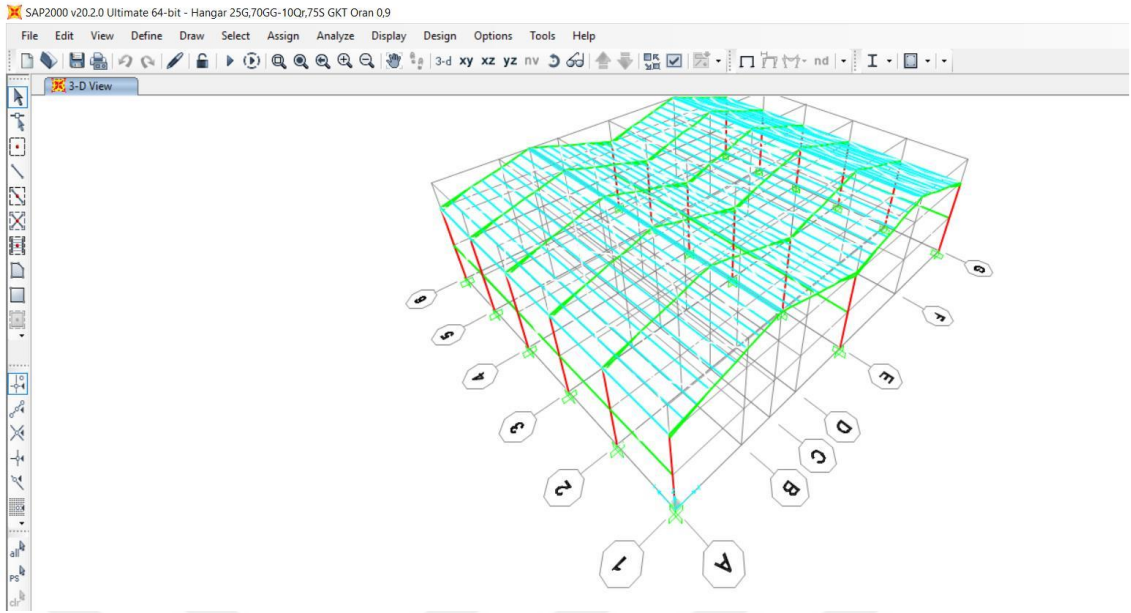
'da hangar tipi çelik yapının aşık planı gösterilmiştir.
